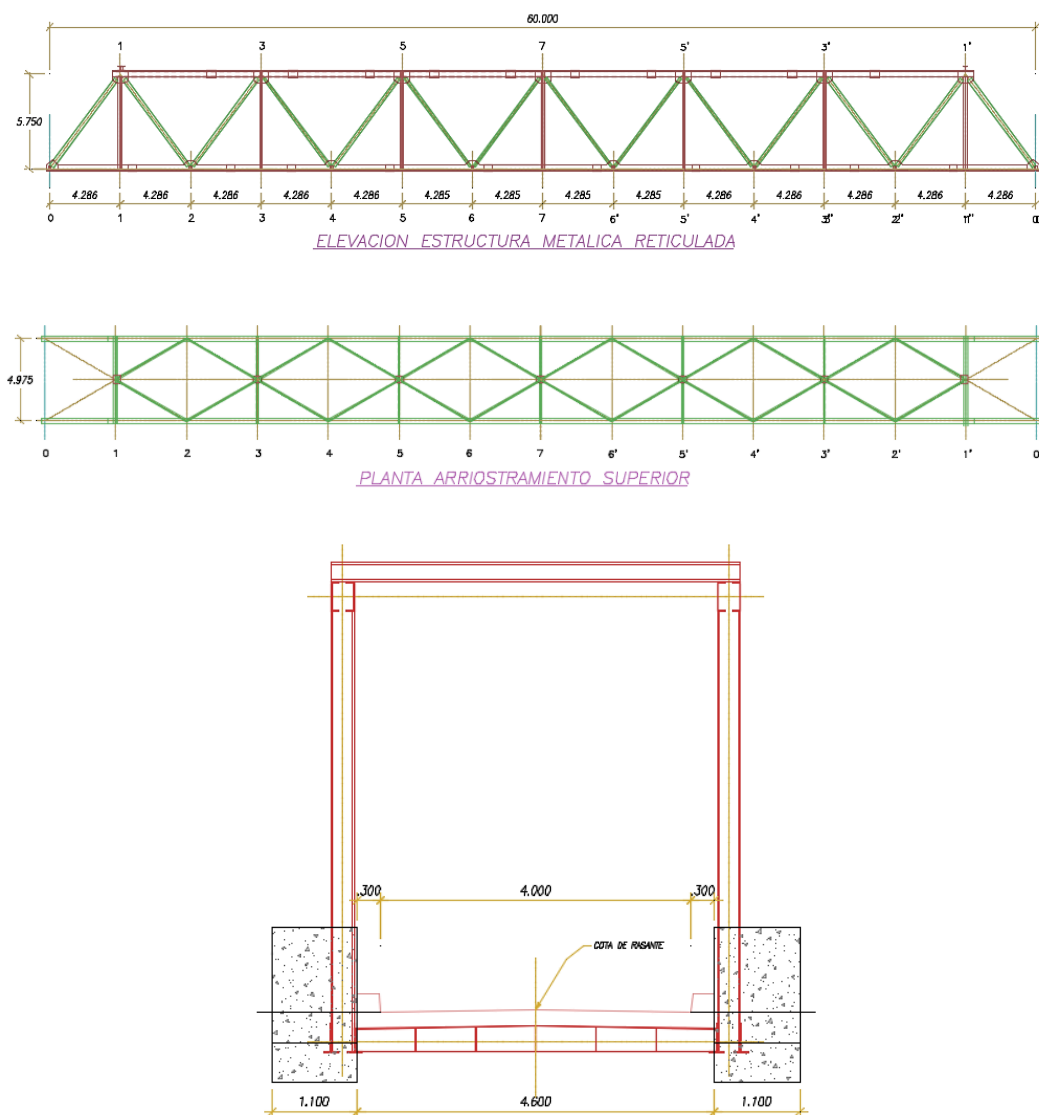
Vista en elevación, planta y sección transversal del antiguo Puente Chupuro
